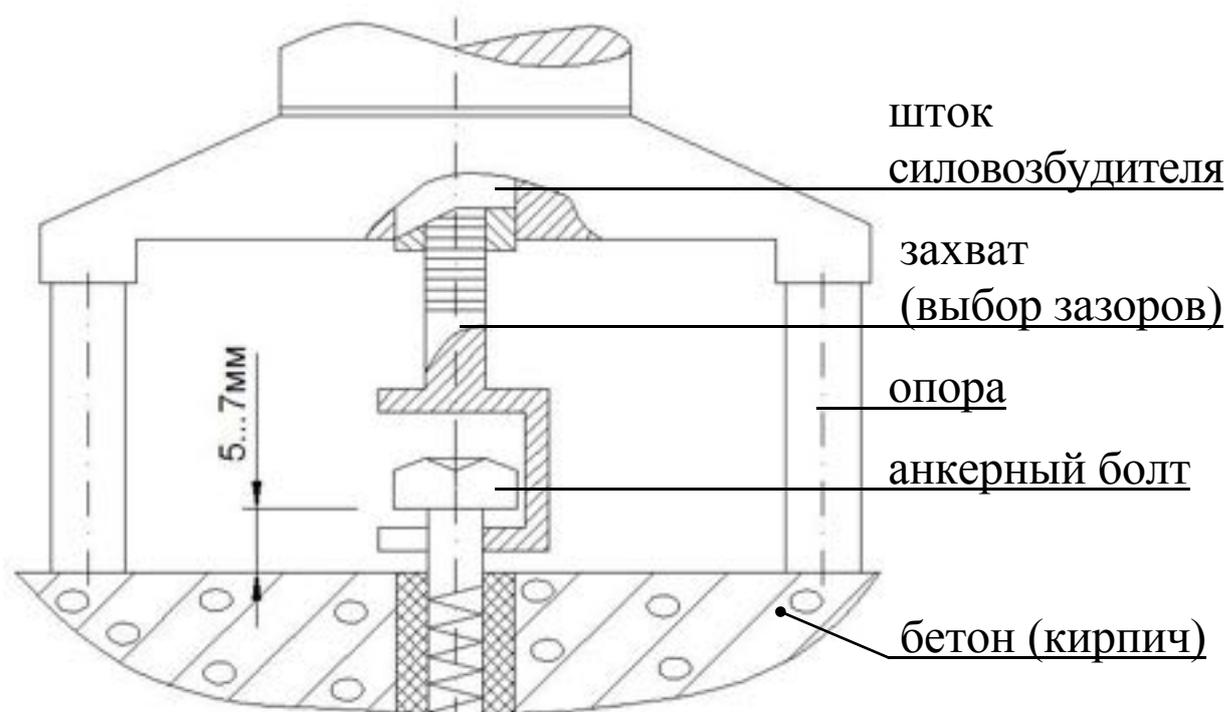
Схема подготовки прибора ПСО-МГ4АД к измерениям
